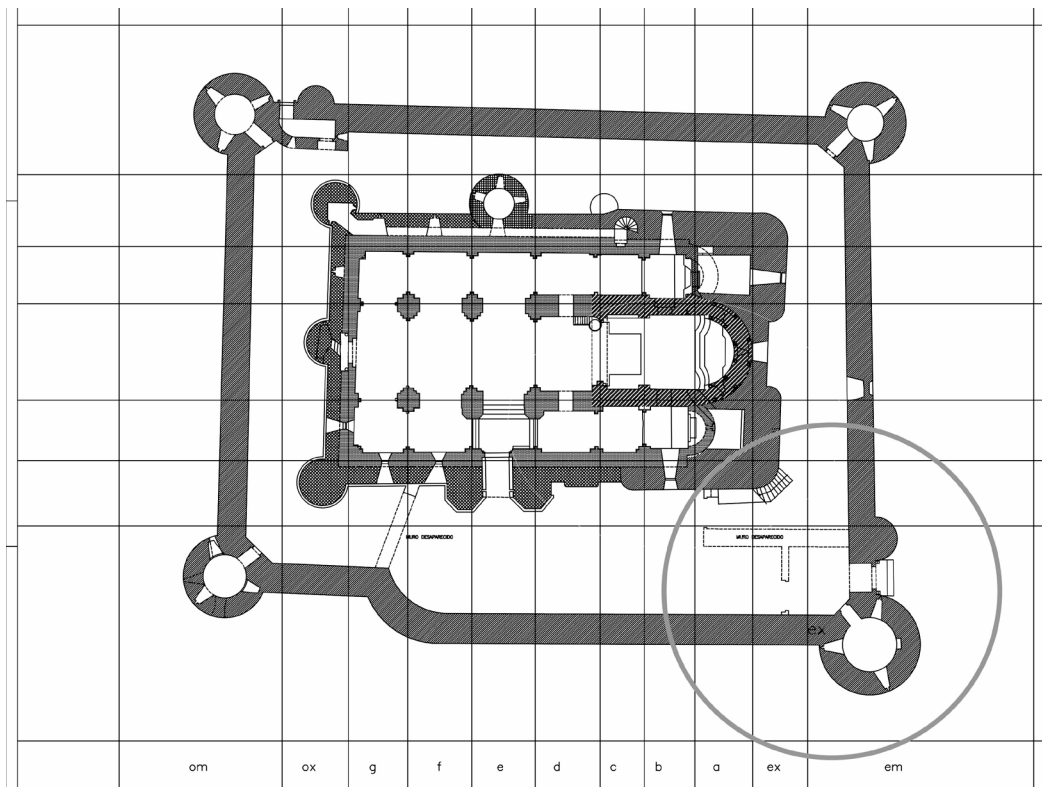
Traza de los restos descubiertos por Pilar Barahona en 1996, e incorporados al plano del Plan director (Alberto García Gil).
